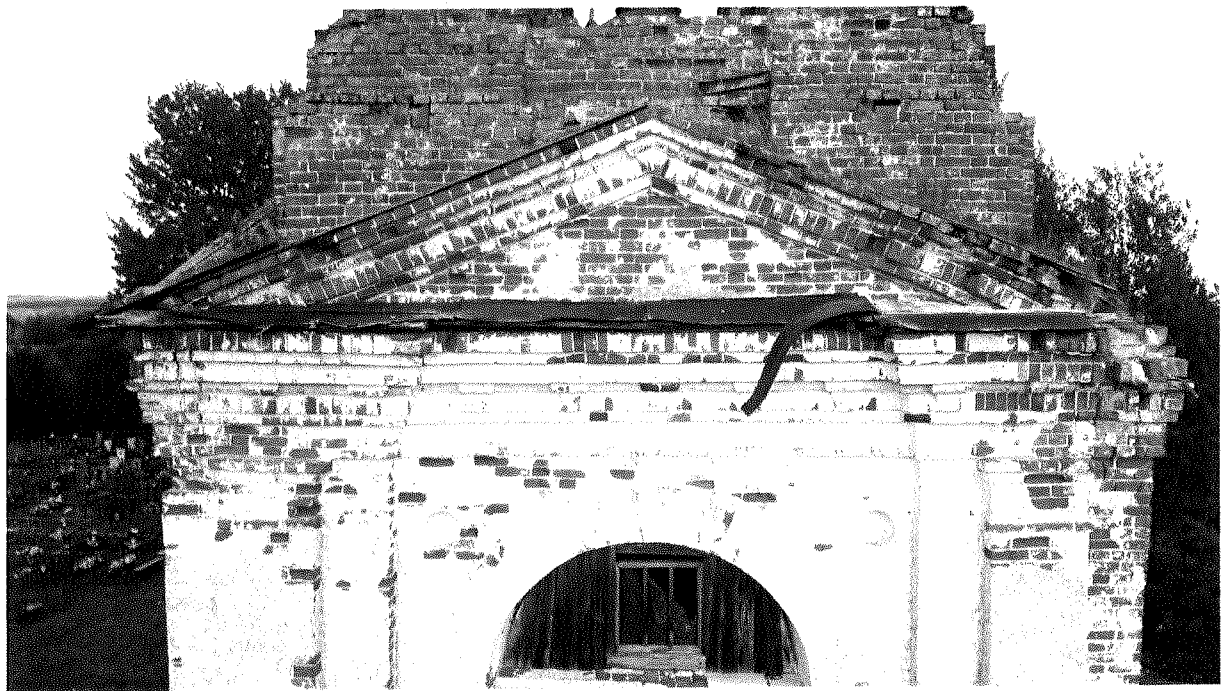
Колокольня. Западный фасад. Западный фасад. Фронтон
